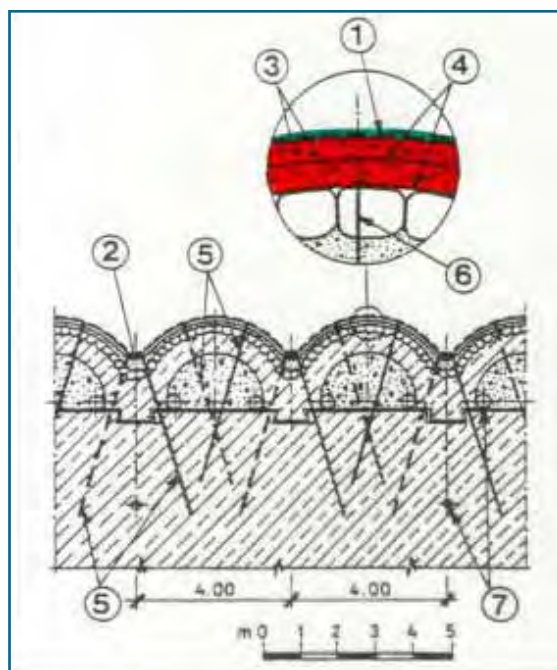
Diga di Ceresole Reale (TO): schema di rivestimento del paramento di monte: 1) geomembrana, 2) dispositivo di fissaggio, 3) calcestruzzo proiettato, 4) reti metalliche, 5) ancoraggi profondi, 6) chiodo di fissaggio, 7) dreni verticali [A.E.M. Torino].
